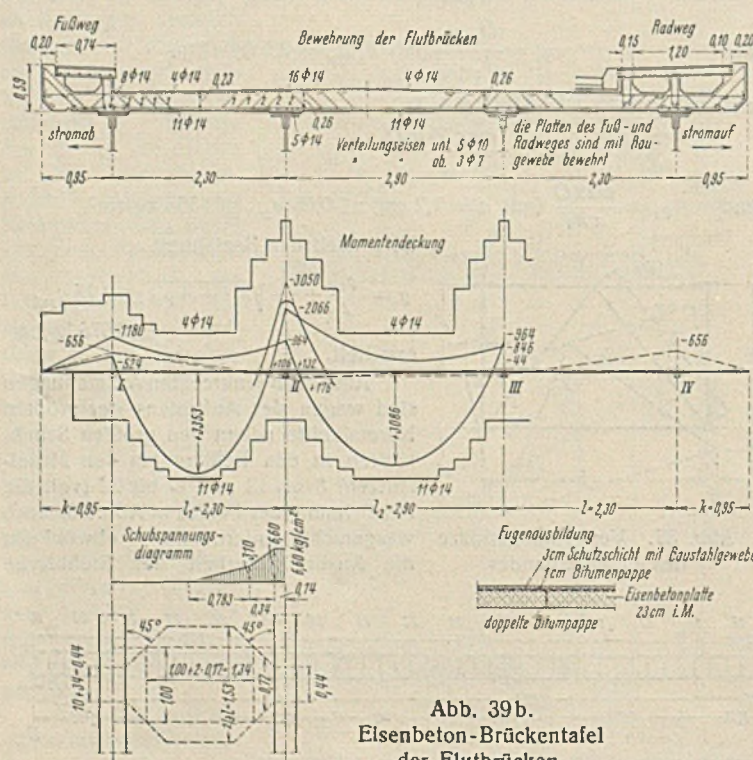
Eisenbeton-Brückentafel der Flutbrücken.
